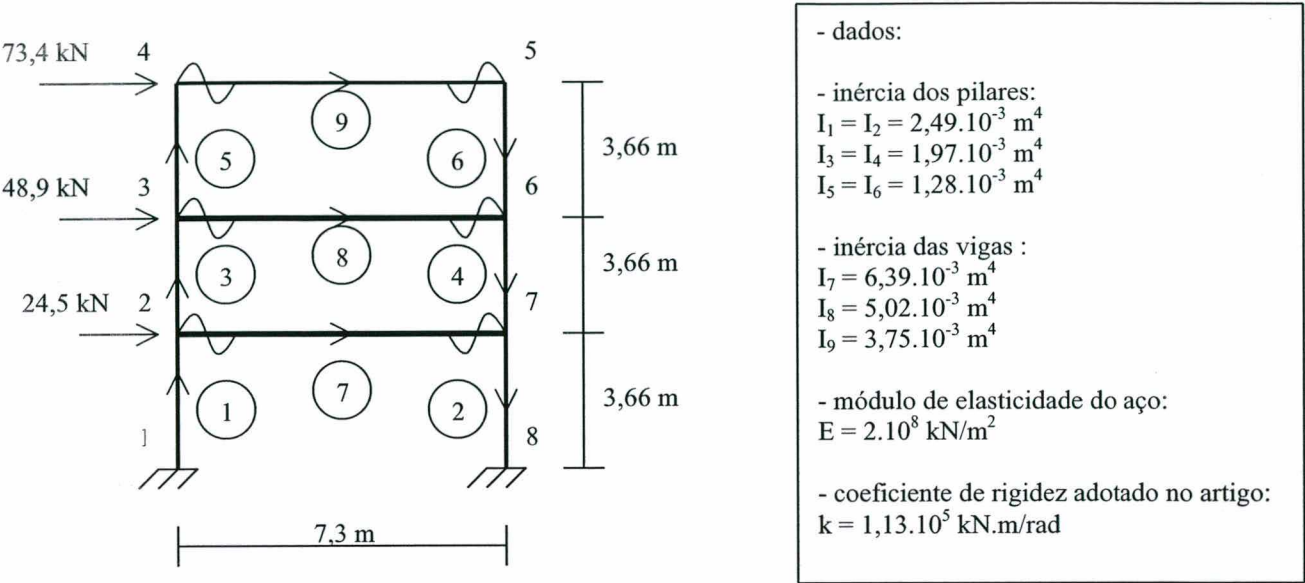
Pórtico plano de três andares com carregamento lateral e “molas” aplicadas nas vigas.
